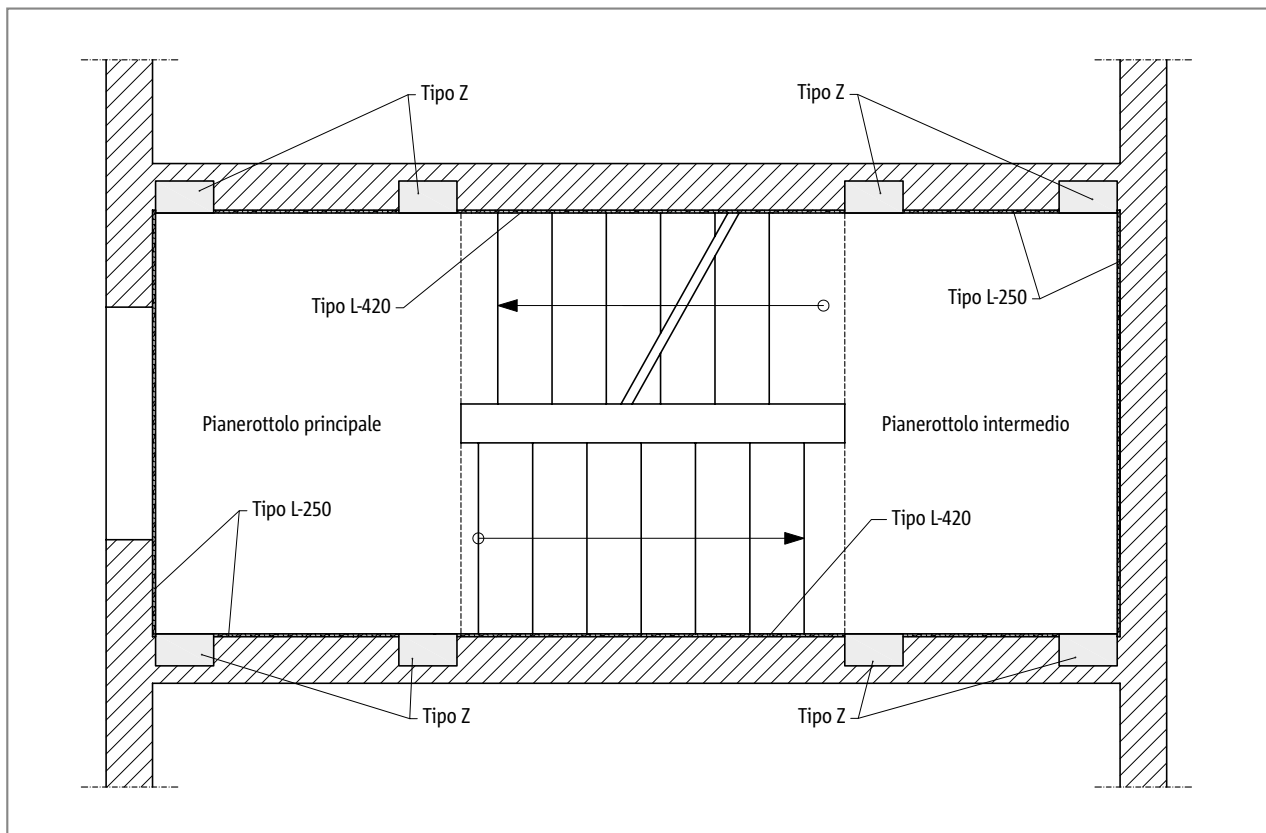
Schöck Tronsole® tipo L-250 e tipo L-420, soluzione per l'isolamento acustico di rampe e pianerottoli con l'impiego di Tronsole® tipo Z
